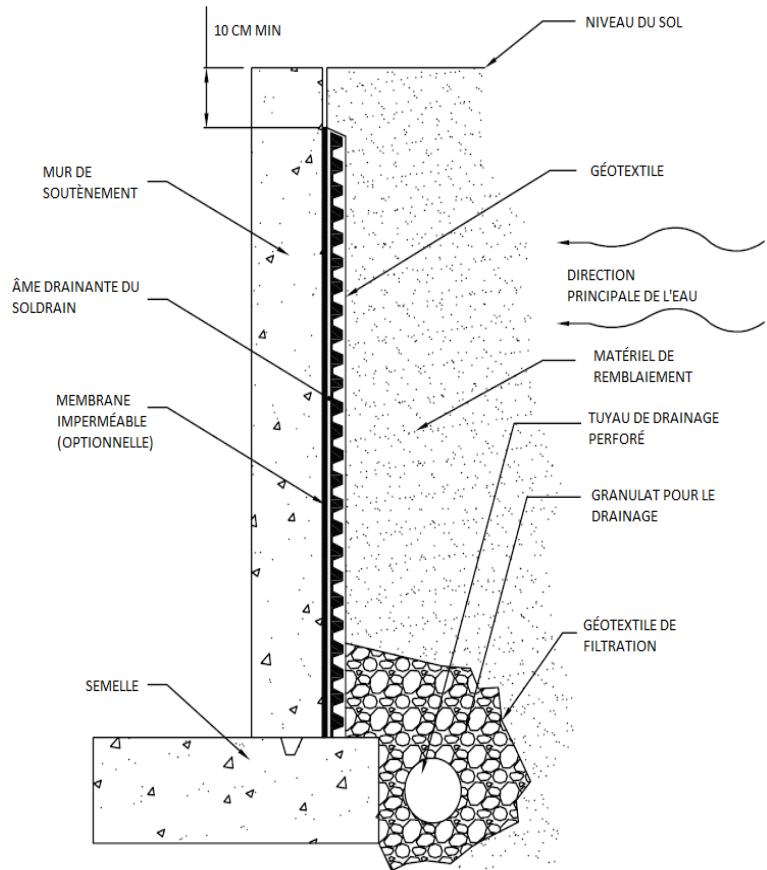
Exemples d'installations et de raccordements avec et sans dépassement du Soldrain
